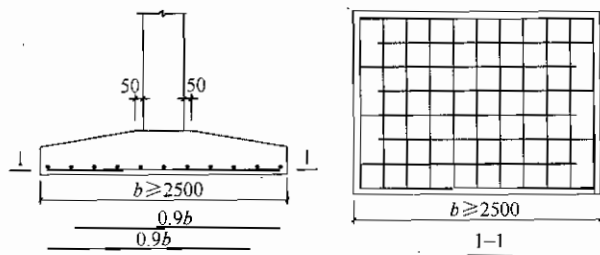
柱下独立基础底板受力钢筋布置
